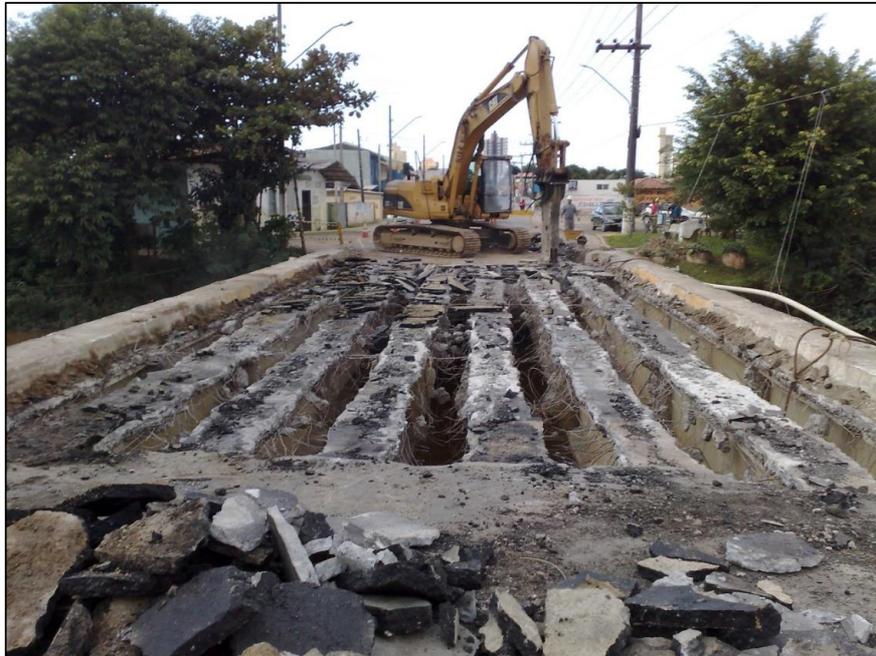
Escavadeiras rompendo e picando a estrutura de concreto armado e alvenarias.
